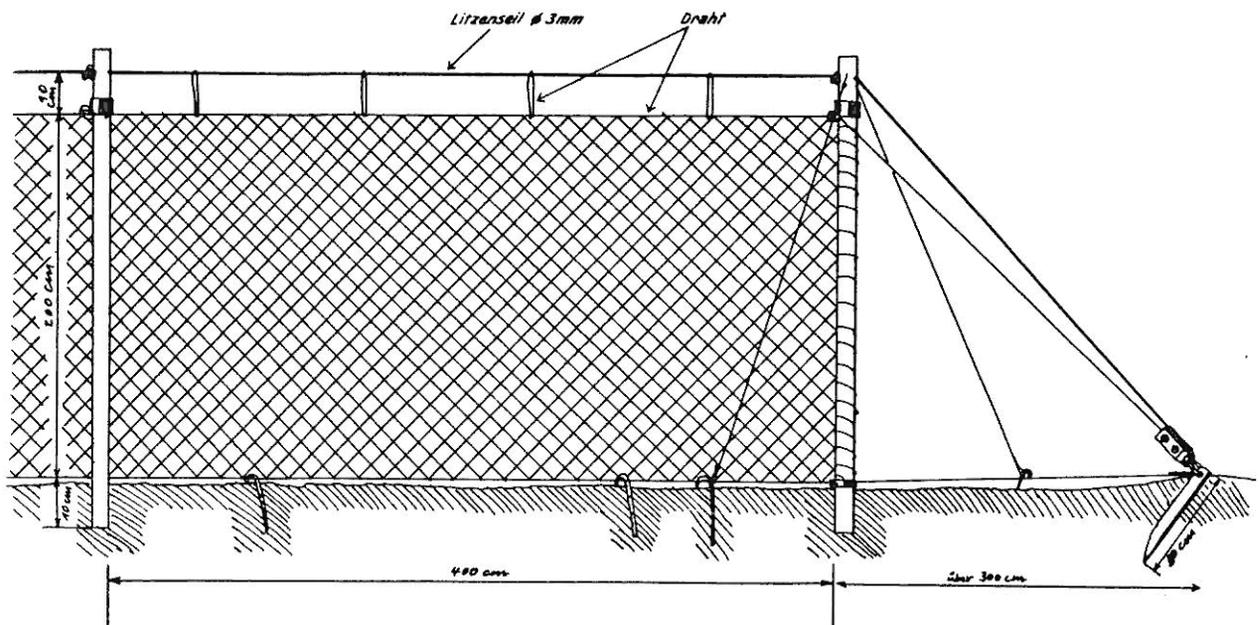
Detail einer beweglich abgespannten Zaunkonstruktion.
